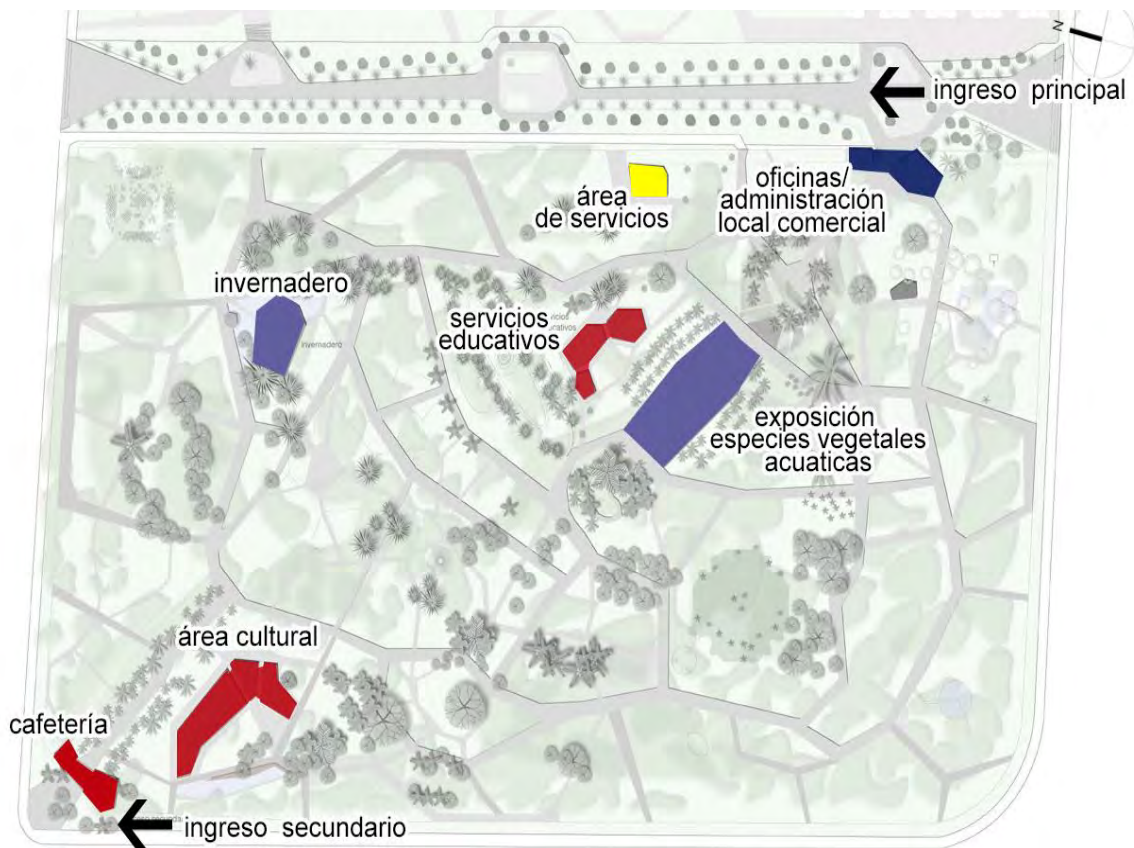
Planta de conjunto, Jardín Botánico Culiacán, México.
